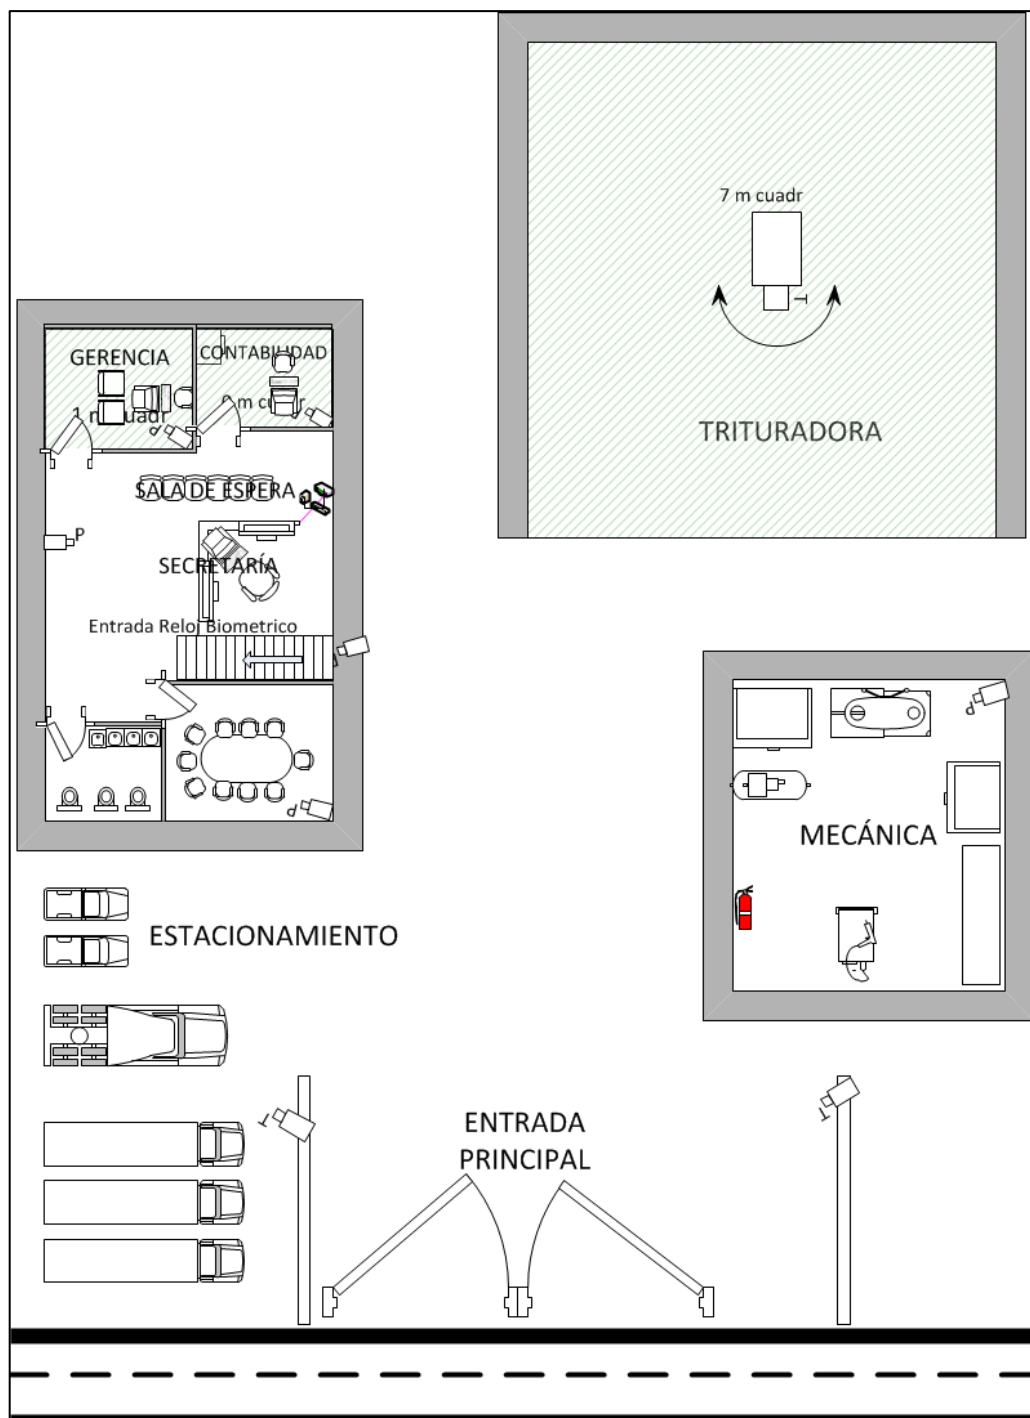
Plano de la ubicación de las cámaras en el sistema propuesto
